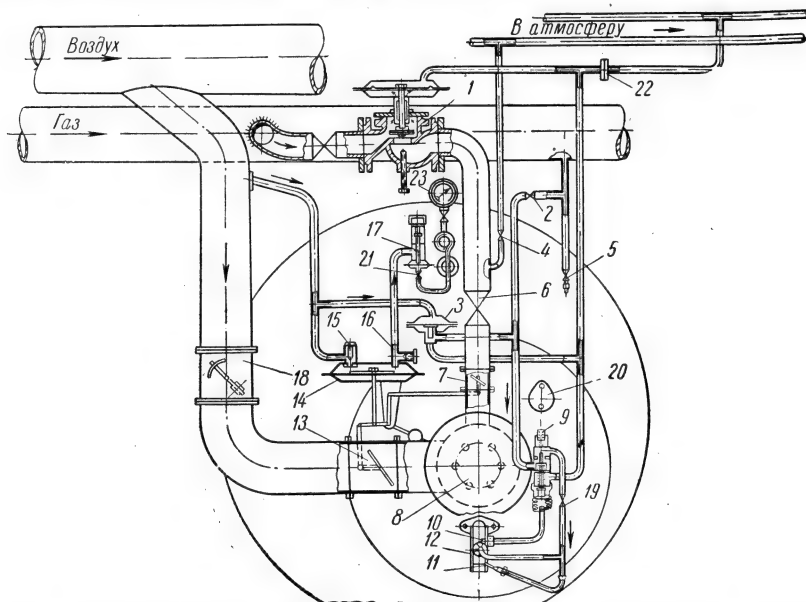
Схема автоматического управления водонагревательными и паровыми котлами, оборудованными газовыми горелками с принудительной подачей воздуха:
